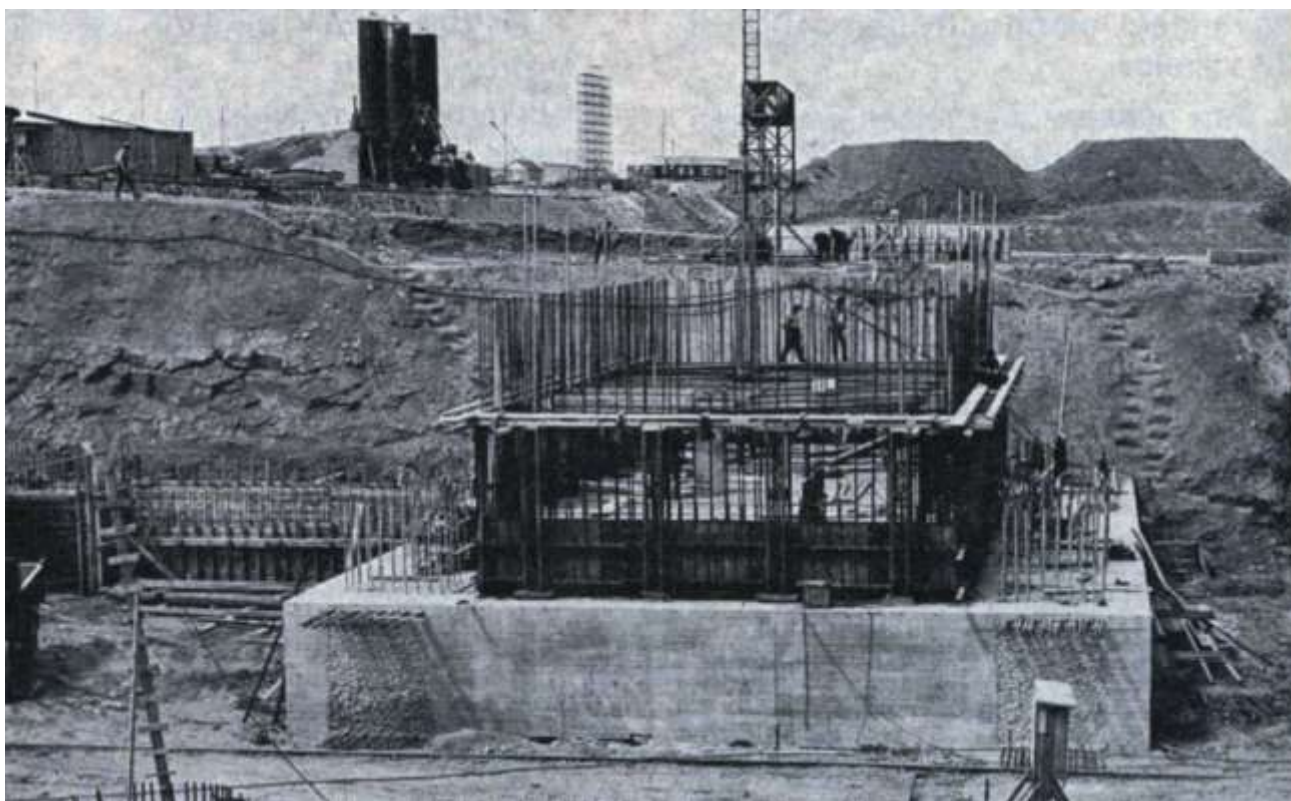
Mise en place du coffrage mobile sur la semelle de la tour. On distingue à l'arrière-plan la centrale où était produit tout le béton nécessaire à la construction de la tour
